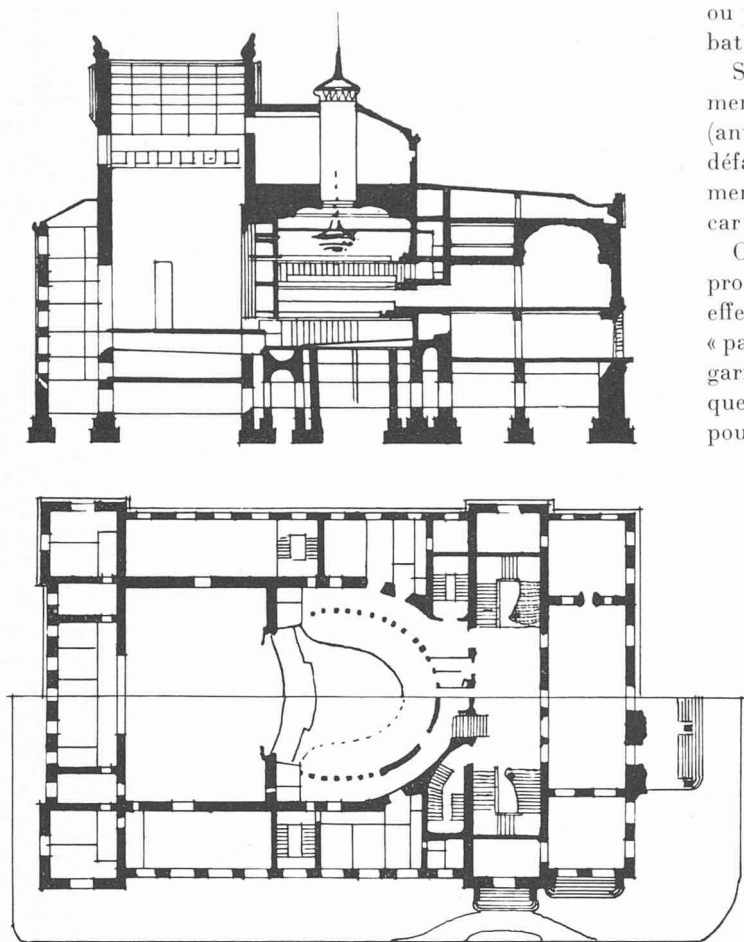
Coupe et plan d'un théâtre du type « français ».
